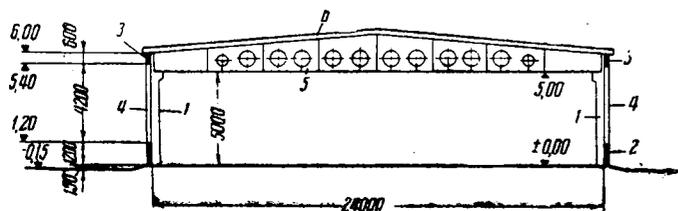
Здание деревообрабатывающего цеха с пролетом 24 м из сборного железобетона (разрез):
